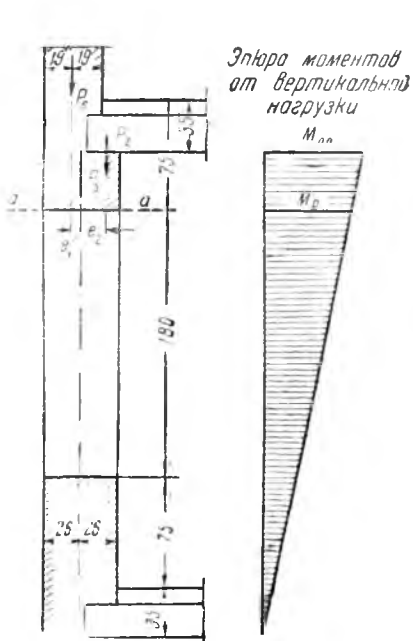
Эпюра моментов от вертикальной нагрузки в простенке 3-го этажа
